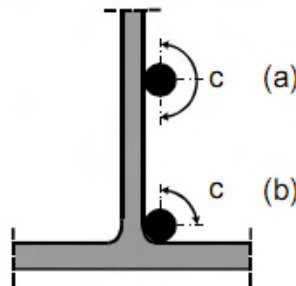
Perímetro efectivo  $c$  de la barra de armado
